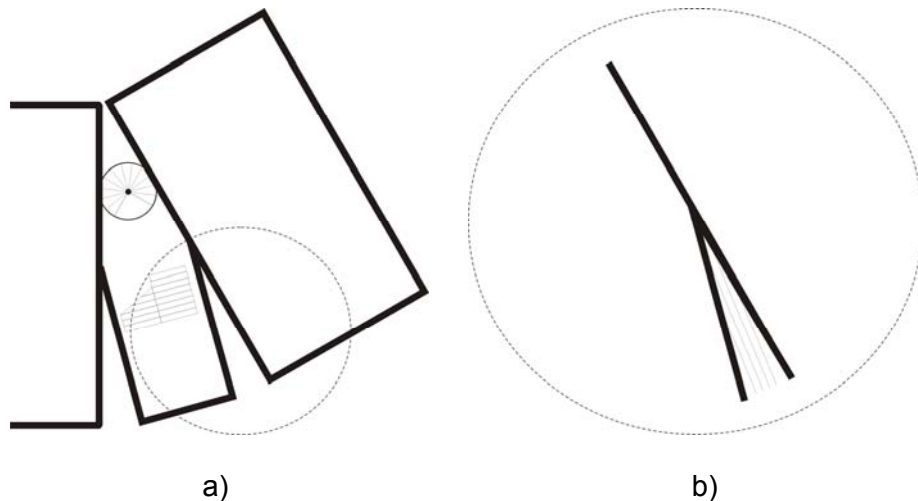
(a,b). Клуб коммунальщиков на Стромынке - схема построения конструктивных узлов в местах пересечения конструкций консолей клуба и лестничных узлов (арх. К. Мельников, 1927–1929 гг): а) схема, обозначающая на плане местоположение пересечения конструкций консоли и лестничного узла (схема автора); б) схема конструктивного узла пересечения консоли клуба и лестничного узла (схема автора)
